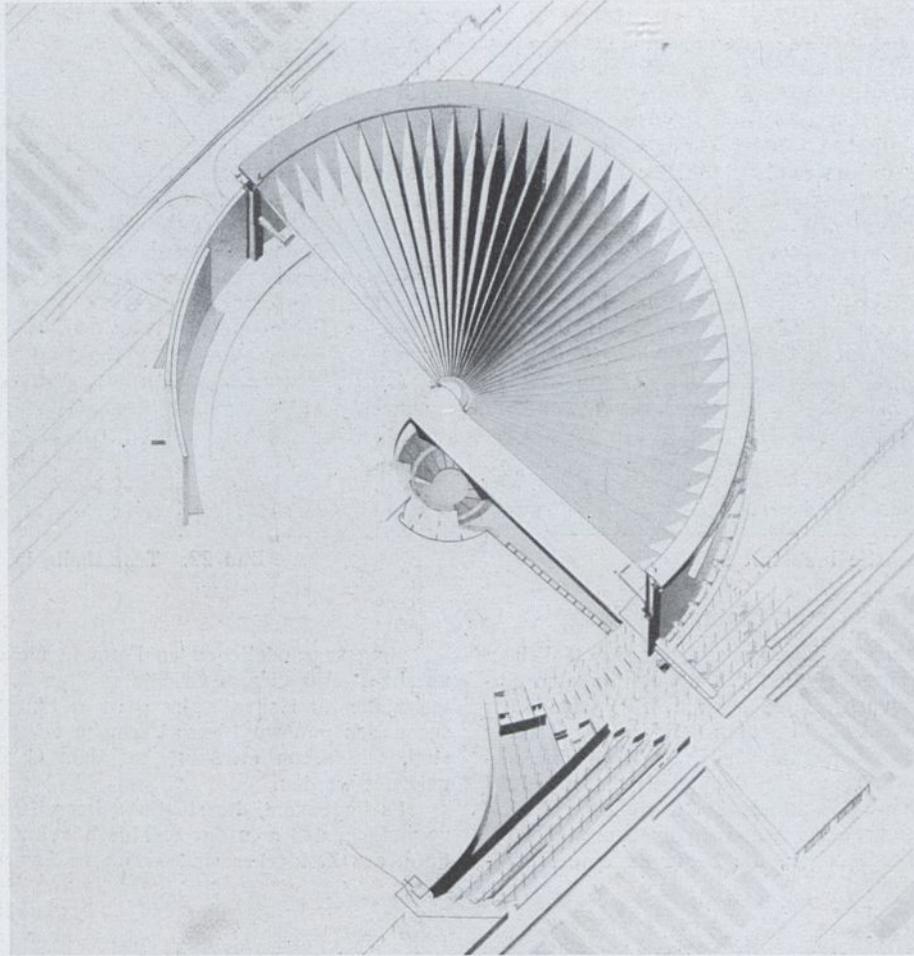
Entwurf Baudouin und Lods für die Pariser Ausstellungshalle.
